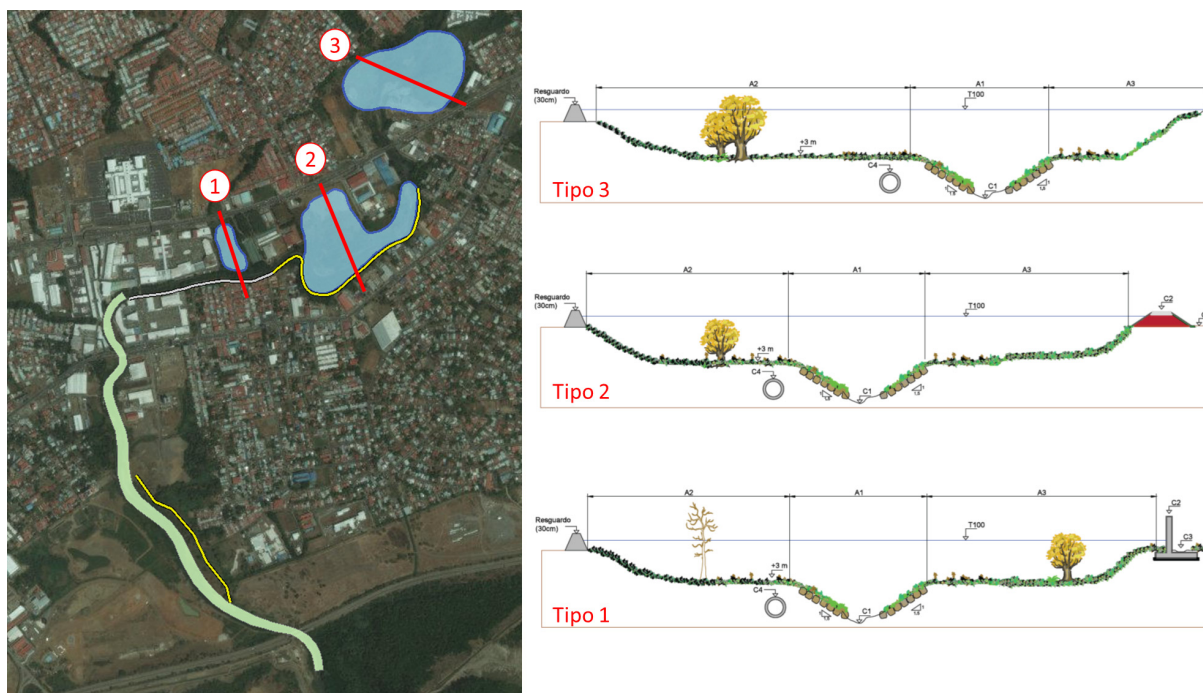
Ubicación en planta de las balsas de regulación libre y secciones tipo.
